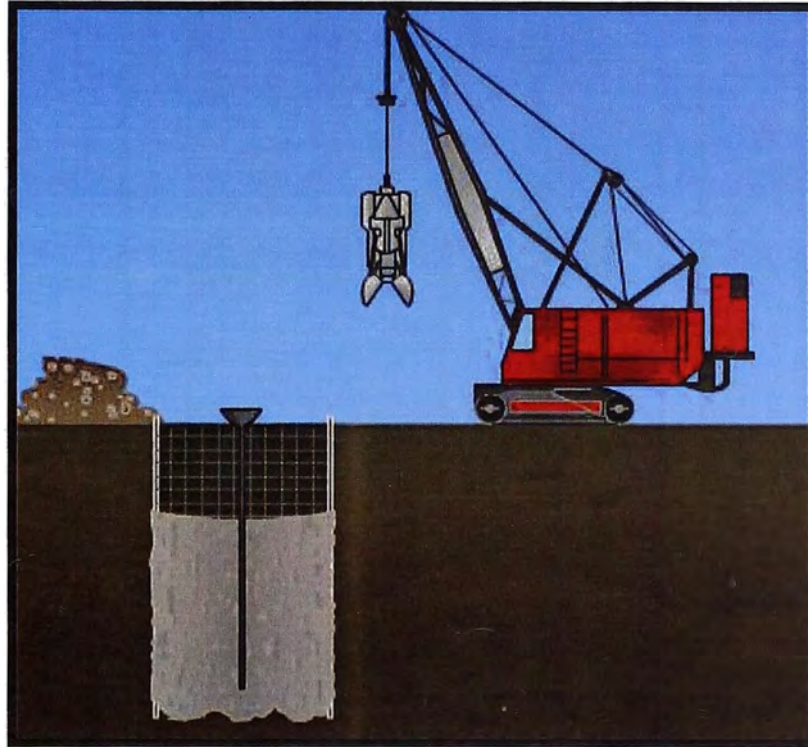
Vaciado de Concreto para el muro pantalla con tubería Tremie.
